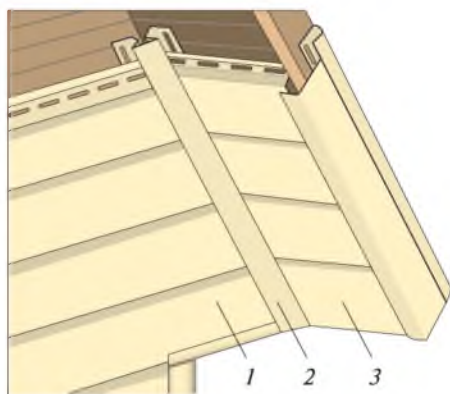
Монтаж внутреннего углового профиля на щипец: 1 – обшивка щипца рядовым сайдингом; 2 – внутренний угловой профиль Döcke; 3 – обшивка свеса крыши соффитами
